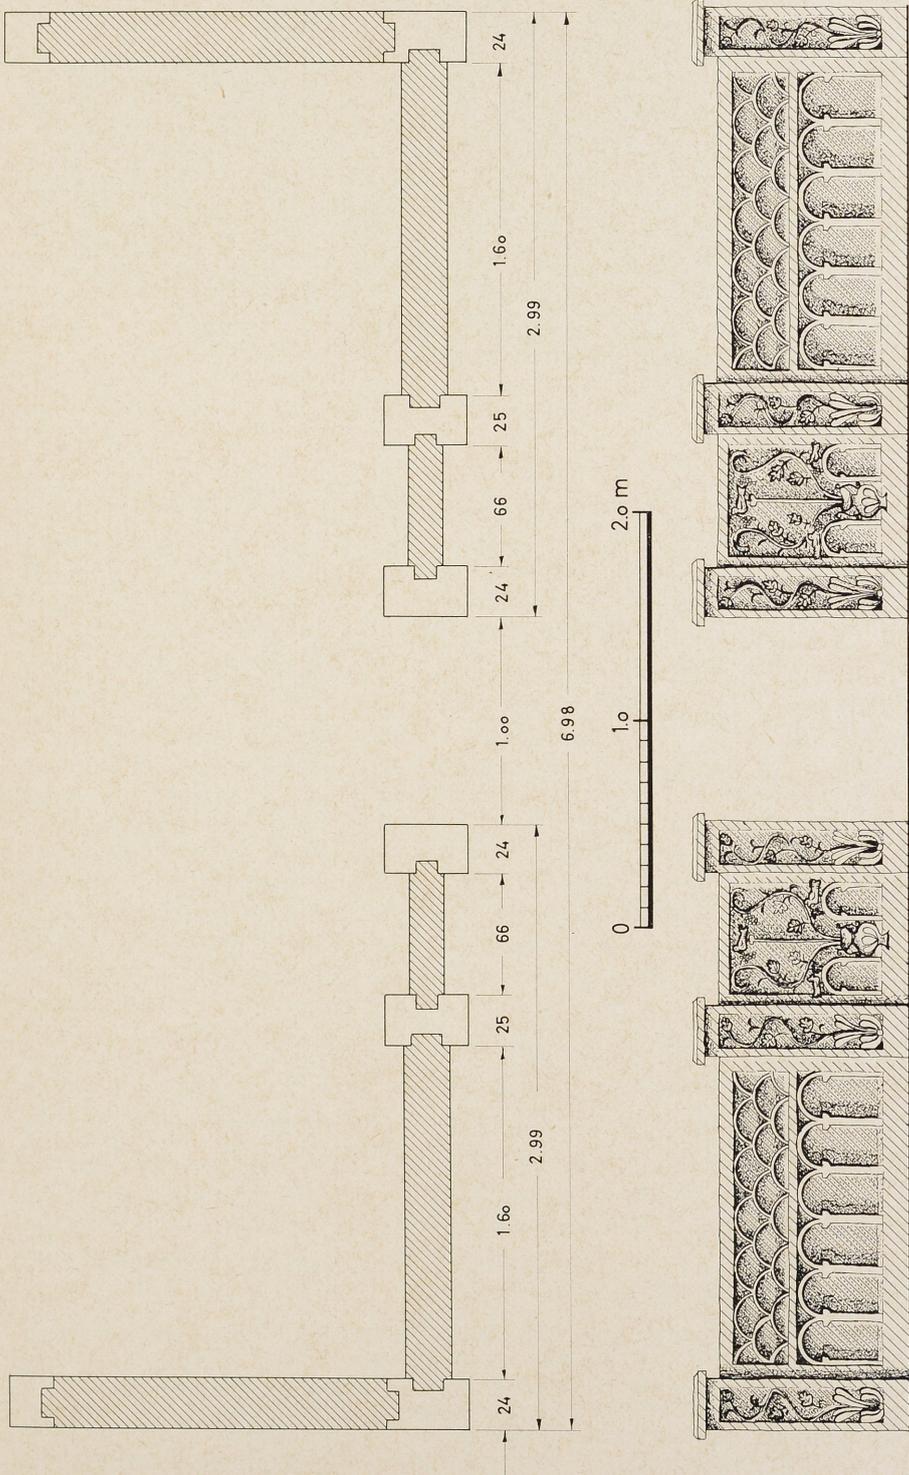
Rekonstruktionsversuch. Ansicht und Grundriß nach den erhaltenen Schranken und Resten
